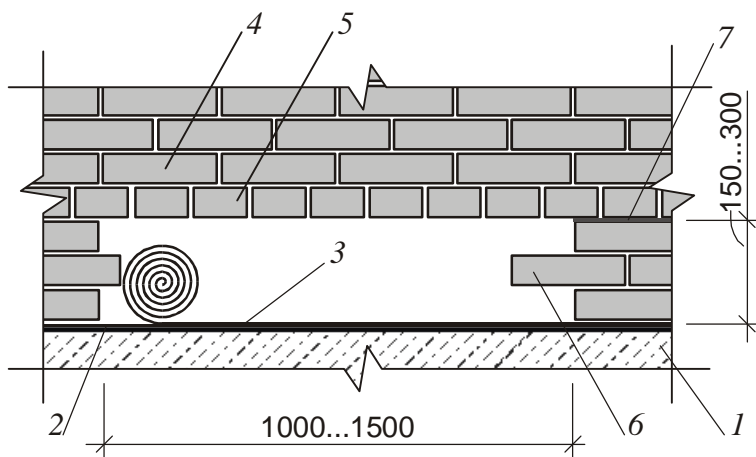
Восстановление горизонтальной гидроизоляции стен методом "подсечки":
